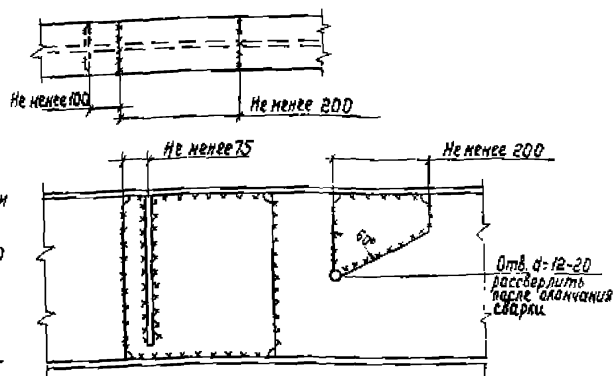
Конструктивные требования к взаимному расположению сварных швов
